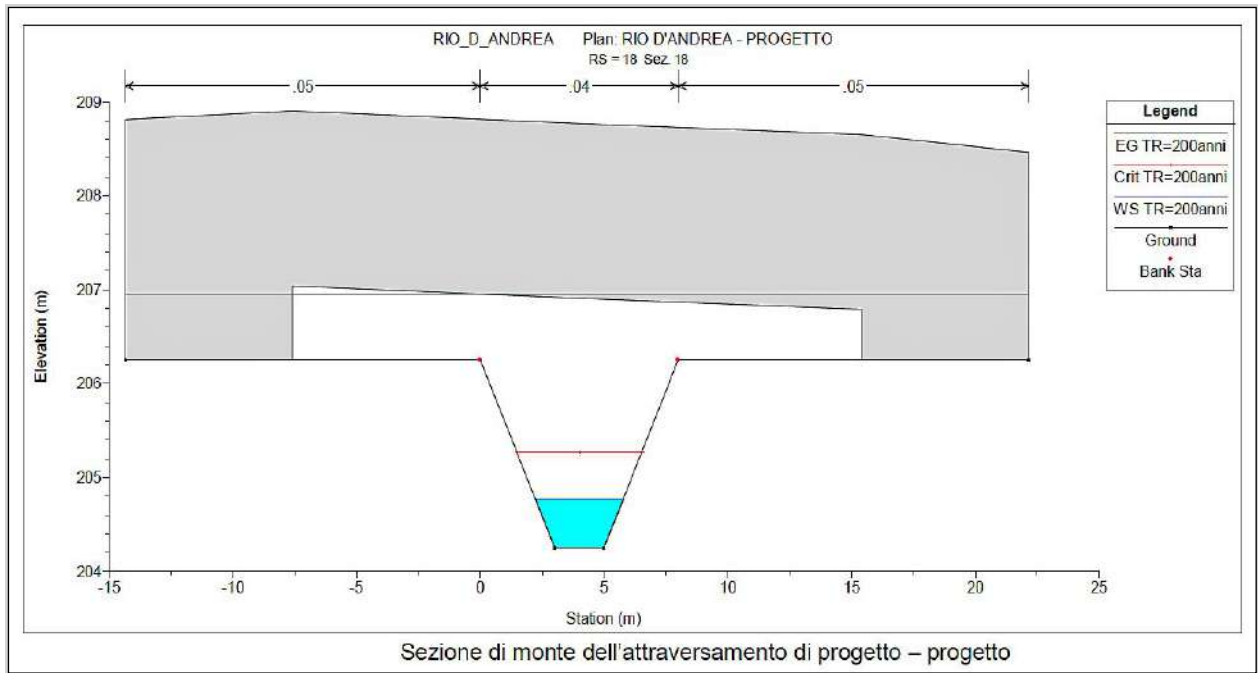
/5 – Sezione trasversale di progetto n. 18
